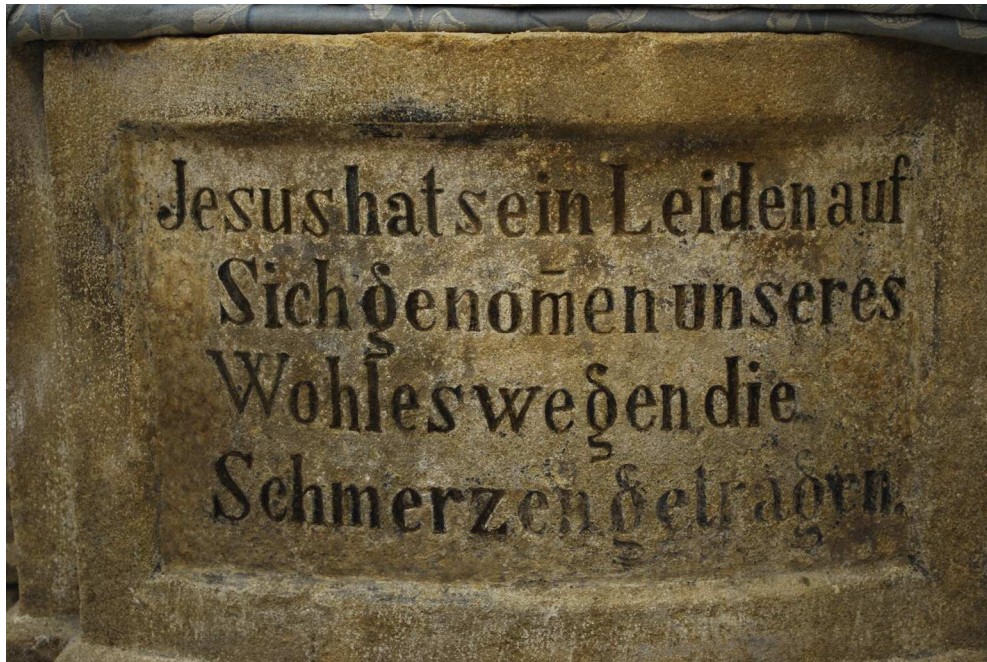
Detail skály kříže, znečištění povrchu - asfalt
